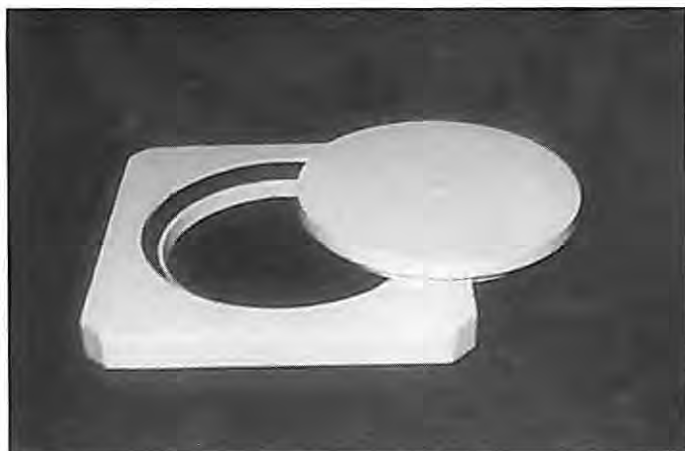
Rahmen und Deckel eines vorgefertigten Einstiegluchs aus Stahlfaserbeton (Foto Cement & Concrete Association G.B.)
